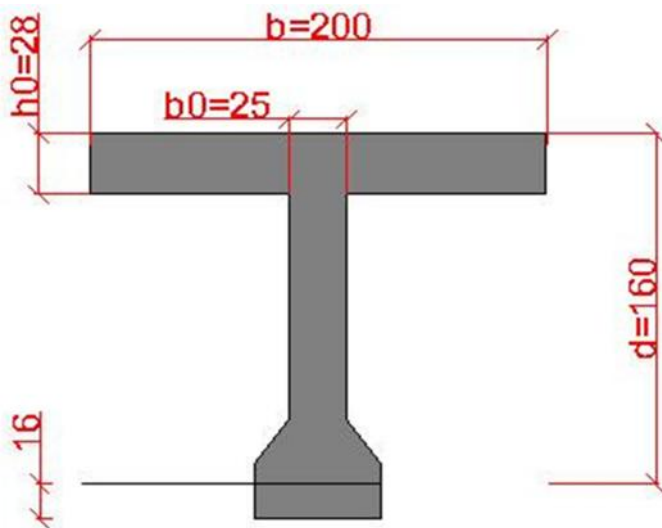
section équivalente de la section médiane (poutre plus hourdis)
